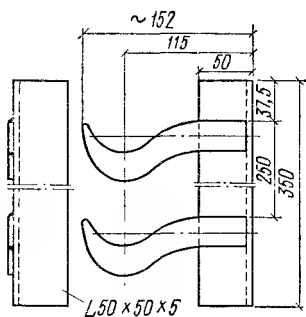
Кронштейн двойной типа 19кс для крепления регистров из гладких труб на кирпичных или бетонных стенах дюбель-гвоздями (масса 1,65 кг)
